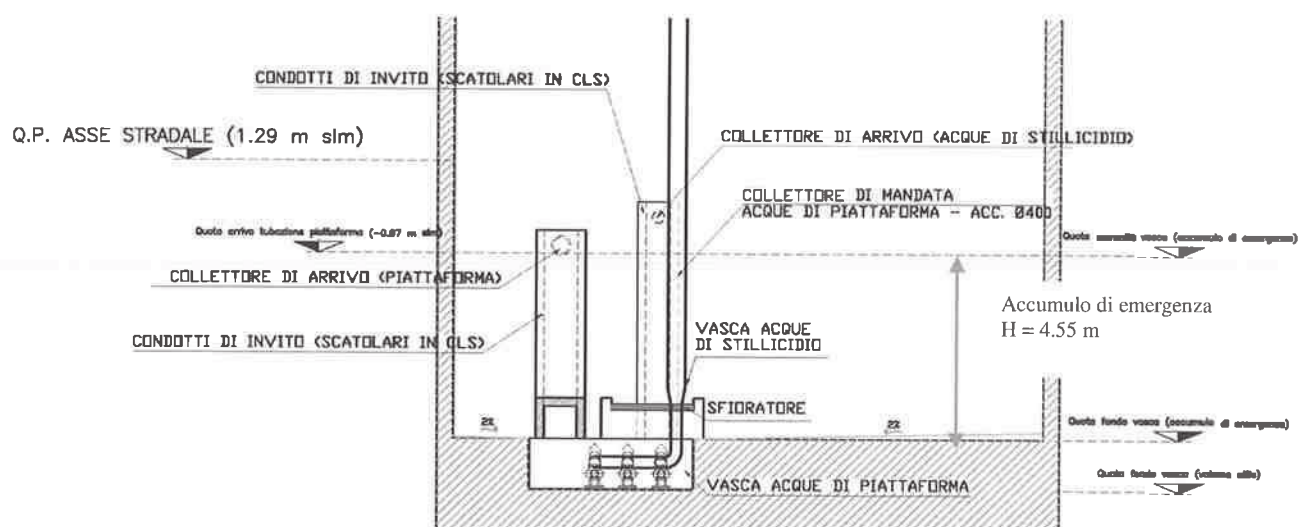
Sezione schematica della disposizione delle vasche per la stazione di pompaggio – particolare del volume di accumulo di emergenza
